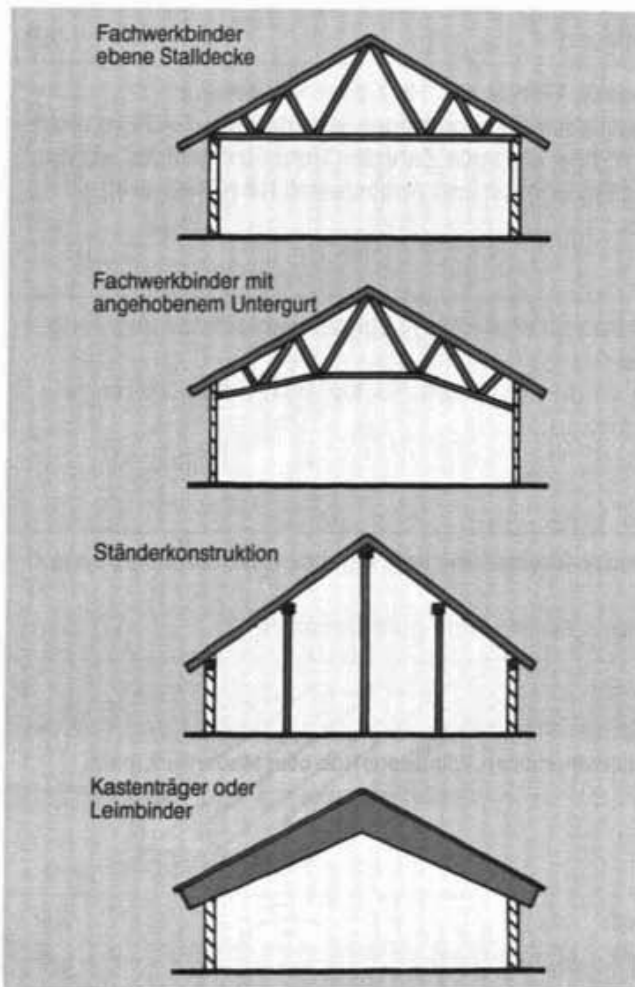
Bauweisen mit unterschiedlicher Dach- bzw. Deckenkonstruktion (ALB).
